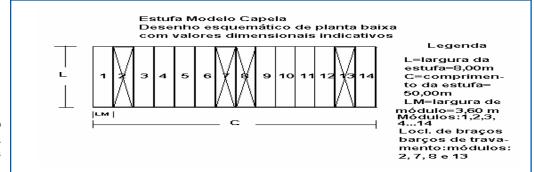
Estufa modelo 'Capela', com planta baixa exibindo detalhes dimensionais.
